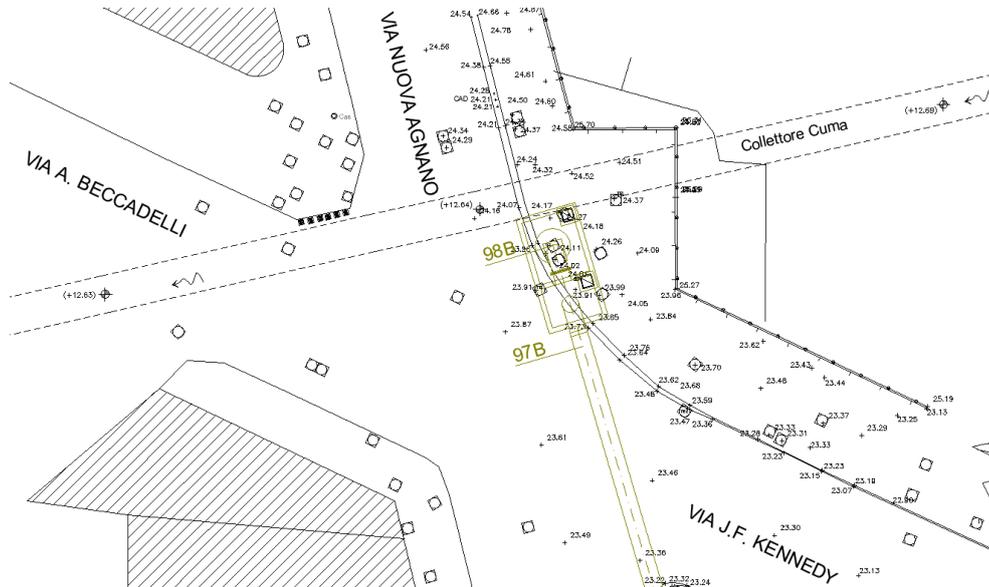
Immissione della premente nel "pozzo B" - Stralcio planimetrico
